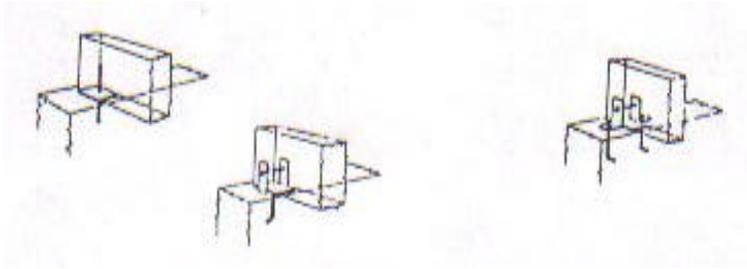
Tipos de uniones de vigas a hormigón.
